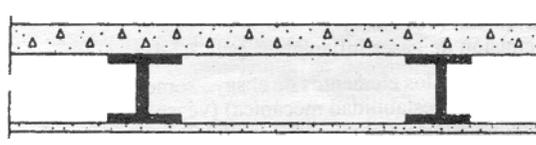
Ejemplo de exposición al fuego de los elementos de construcción
